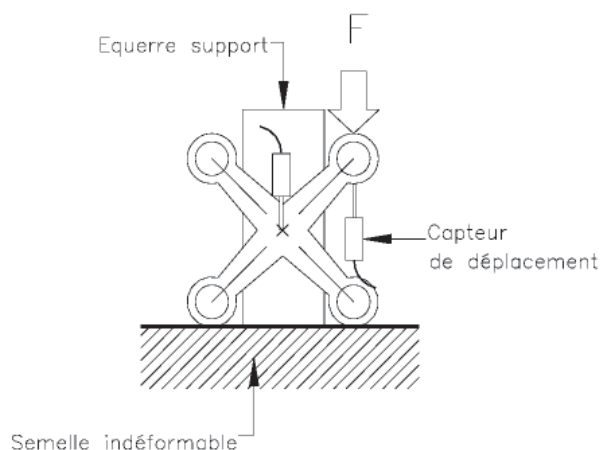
Exemple de chargement parallèle<sup>1</sup> au plan du vitrage sur l'échantillon à 4 branches disposé verticalement
